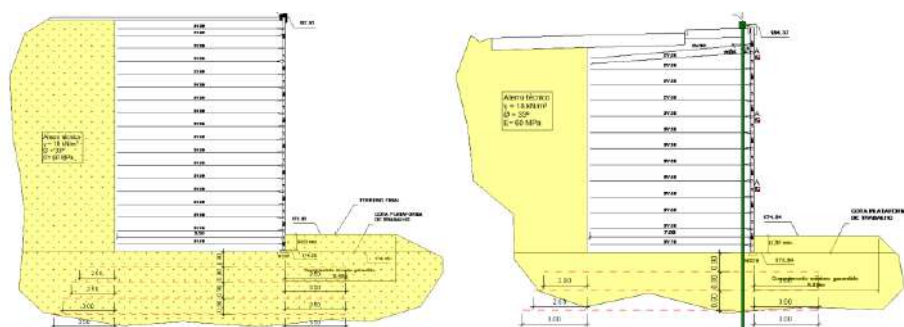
Pormenor de reforço do solo de fundação do muro de terra armada MTA01.
